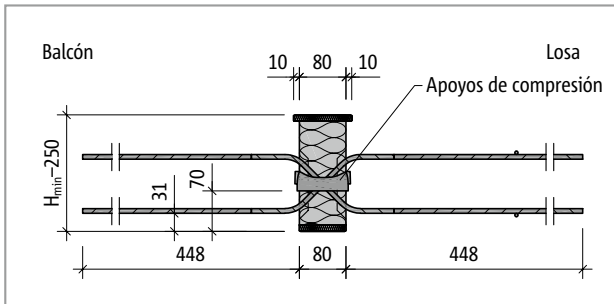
Schöck Isokorb® T tipo Q-VV6: Sección del producto
